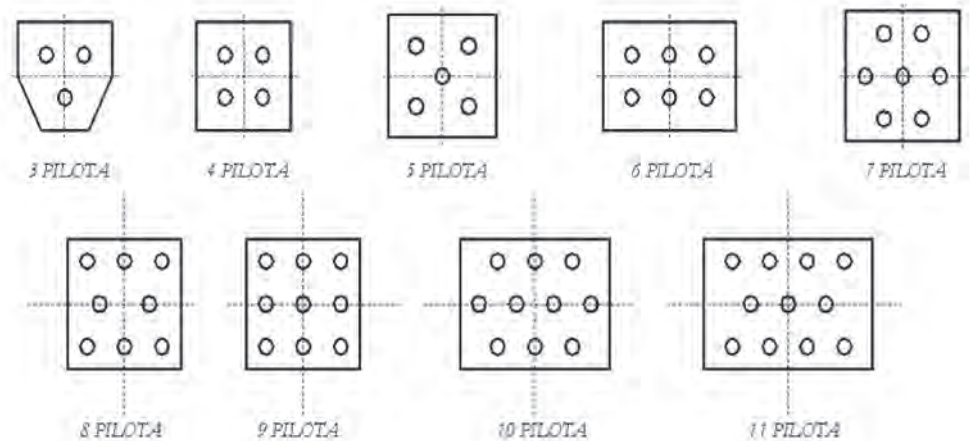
Disa skema të vendosjes planimetricke të grupit të pilotave sipas CRSI, 1992.
